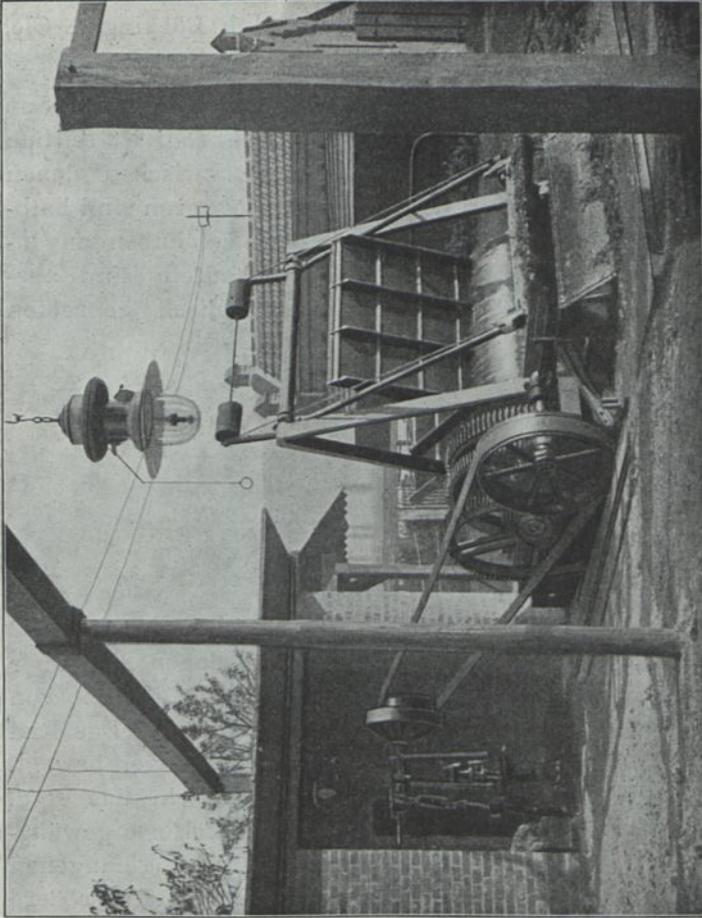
Frankfurter Rechen (Versuchsanlage). Ausführ.: Rudolph Böcking & Cie, G. m. b. H., Halberghütte.
